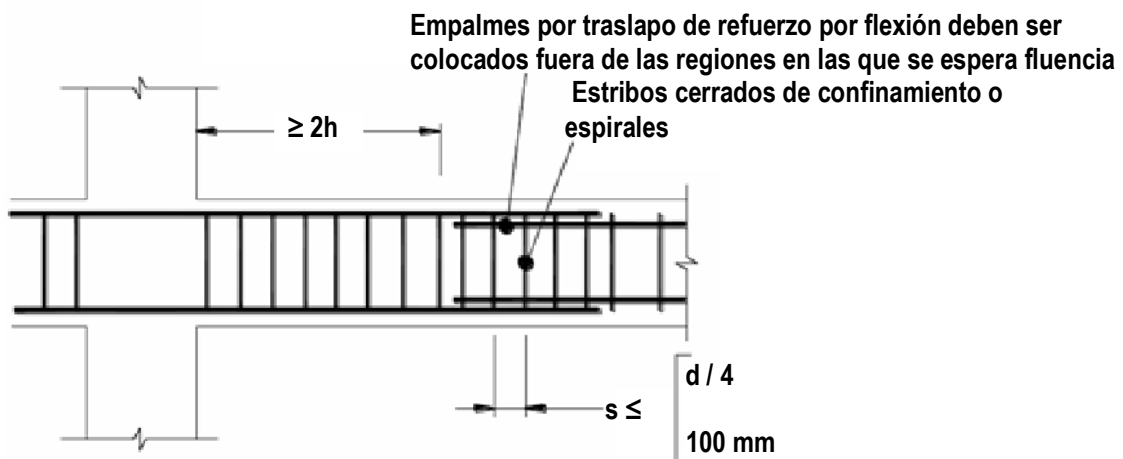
Confinamiento en traslape de varillas de refuerzo longitudinal.
